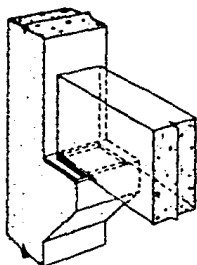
Detalle de conexión entre viga y columna.
